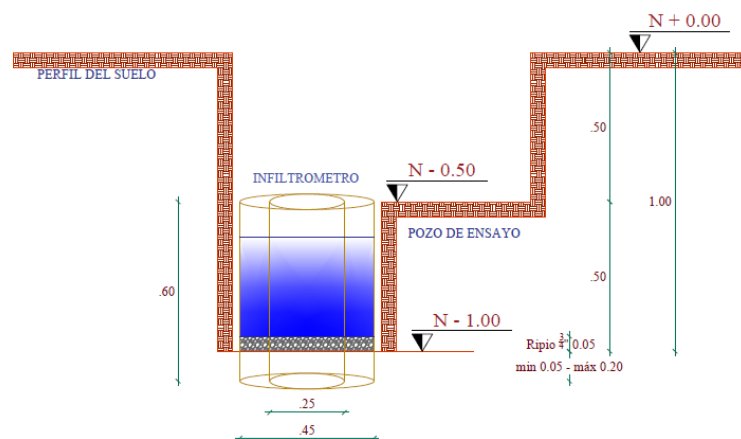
Corte A-A' de la gaveta, pozo de ensayo e infiltrómetro
